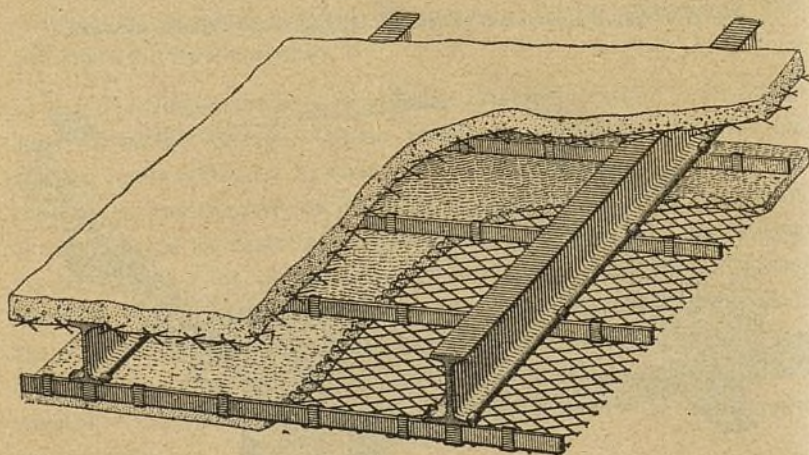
Disposición de un cielo-raso de yeso, suspendido de un pavimento de hormigón con espacio intermedio libre.
